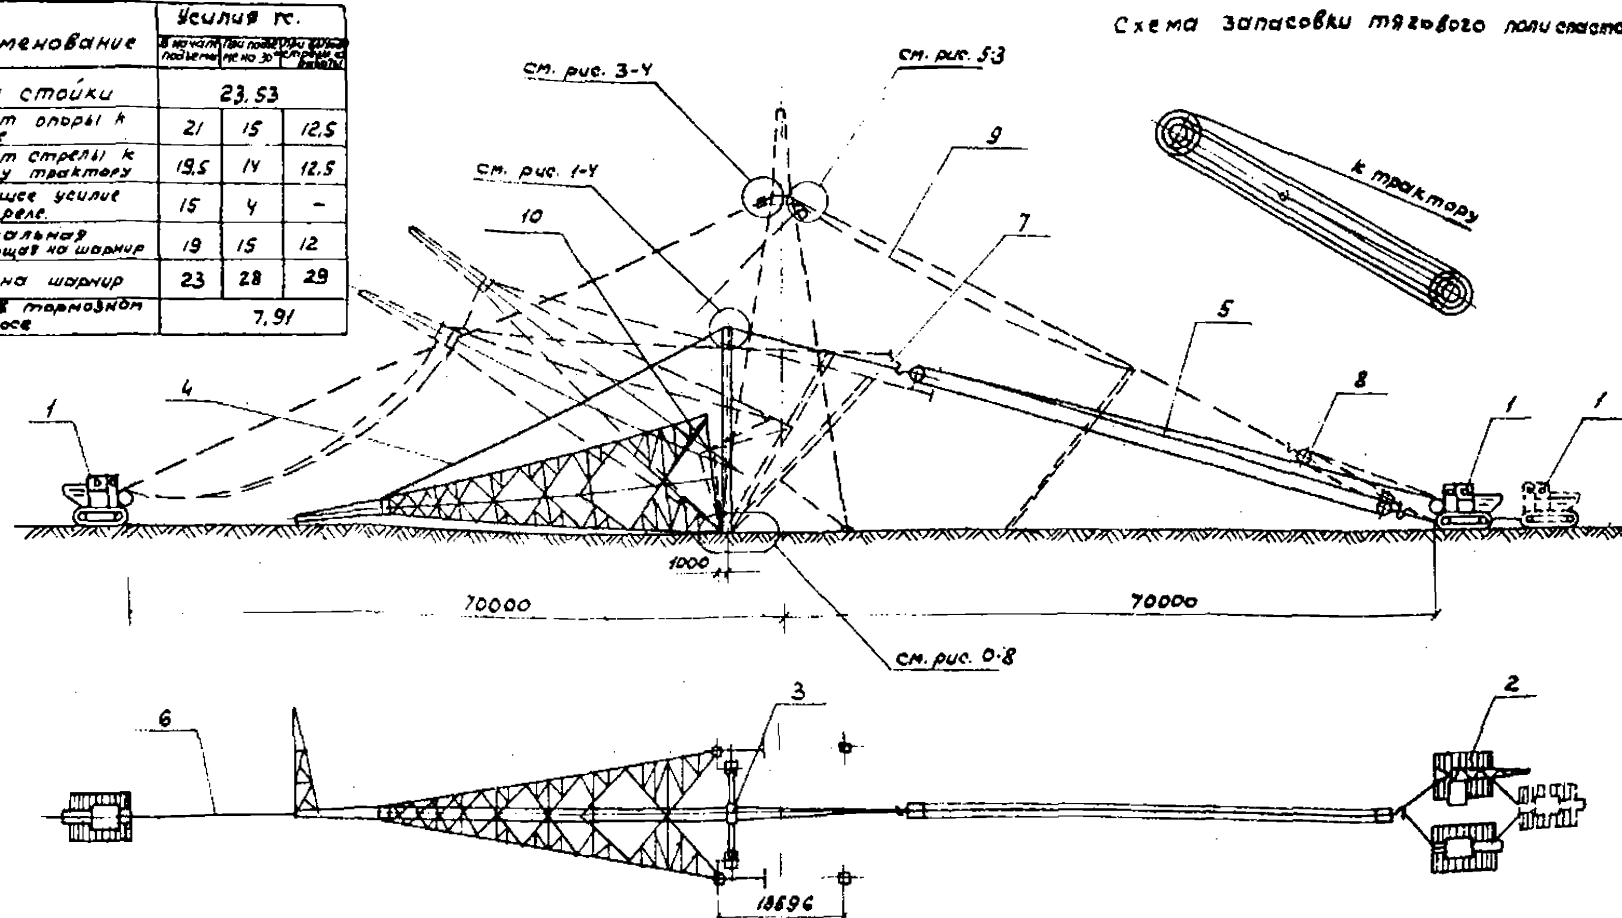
Схема подъема стойки опоры типа УС 750-1+15
